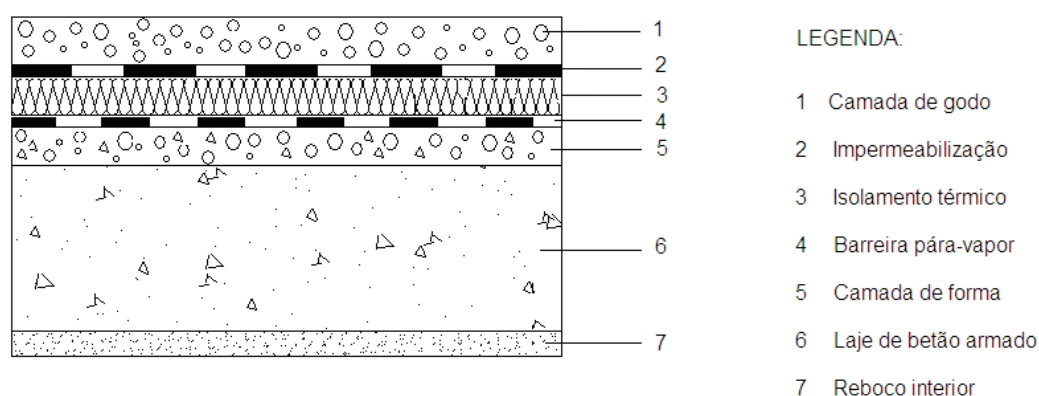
Pormenor construtivo da cobertura horizontal em terraço, com barreira pára-vapor.
